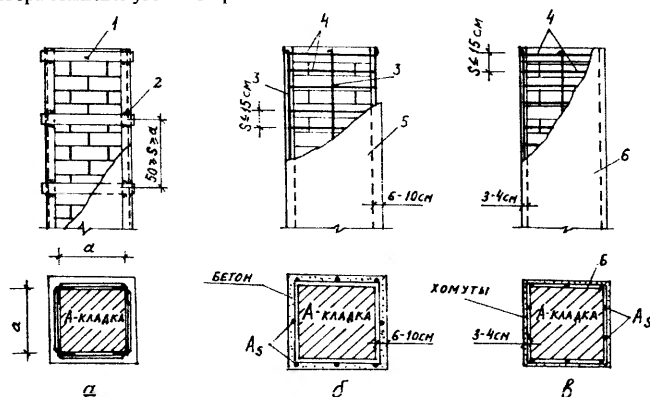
Схемы усиления кирпичных столбов обоймами: а - металлической; б - железобетонной; в - армированной штукатуркой; 1 - планка сечением 35х5...60х12 мм; 2 - сварка; 3 - стержни диаметром 5...12 мм; 4 - хомуты диаметром 4...10 мм; 5 - бетон класса В12,5...В15; 6 - штукатурка (раствор марки 50...100)
